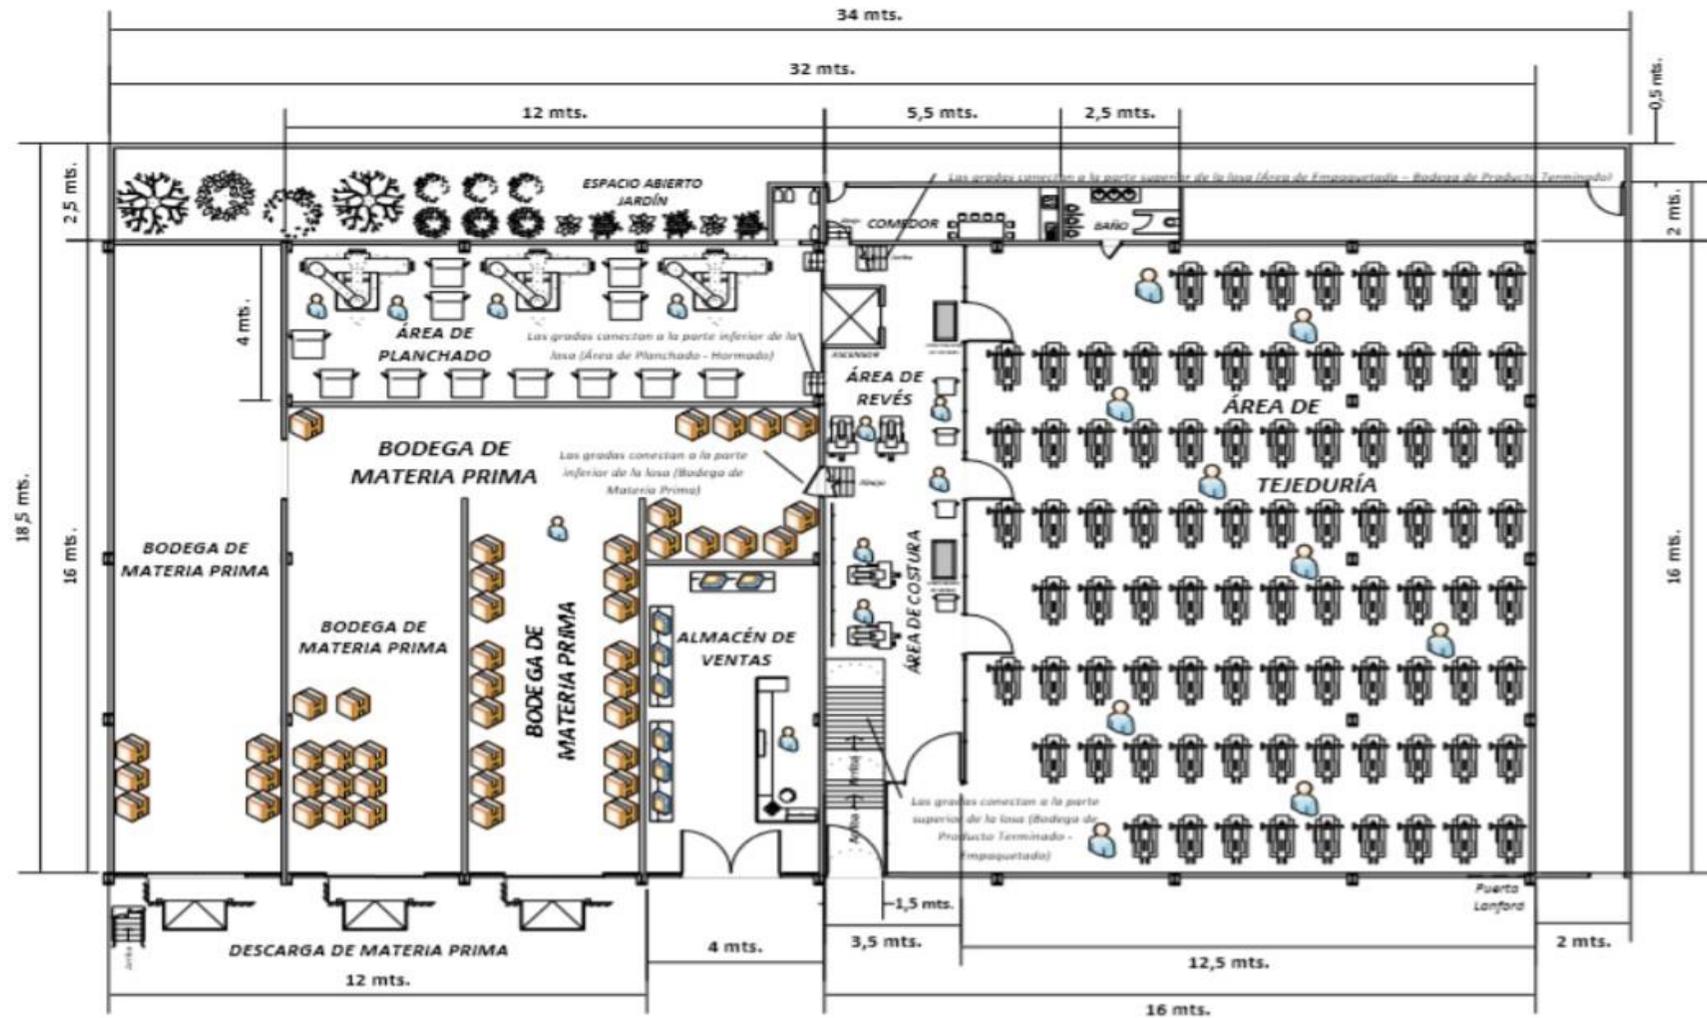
Lay-Out Actual Planta baja de la Empresa PuntoBaytex.
